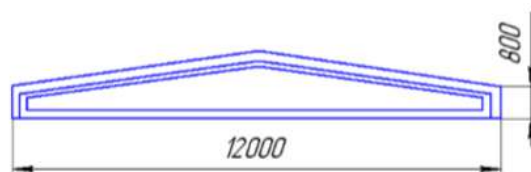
Железобетонная ферма серии 1.462-3
